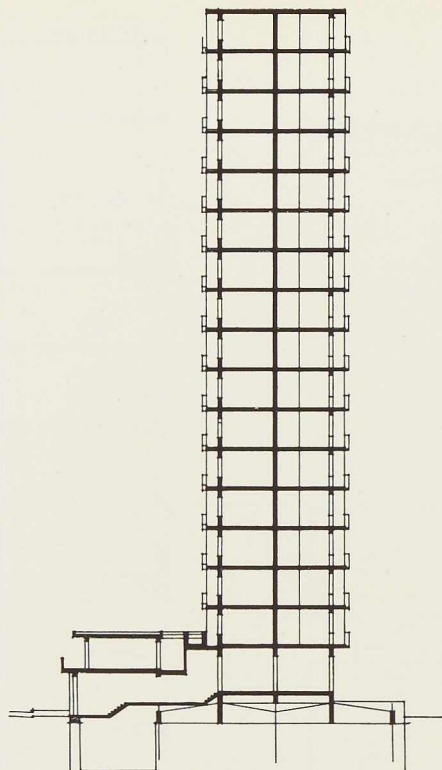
Coupe transversale, variante, avec magasins à front de rue.
